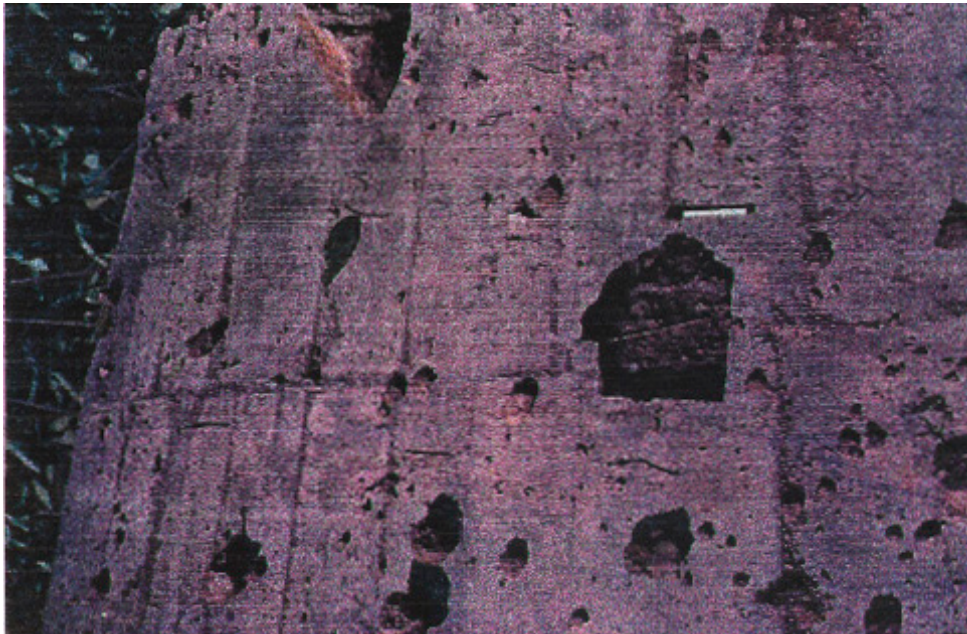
Detalhe de dano na face externa do concreto armado da Cortina 1 (vide foto anterior), referente ao puncionamento exercido pela chapa de apoio da cabeça do tirante, de 20cm x 20cm, guilhotinando literalmente o concreto.
